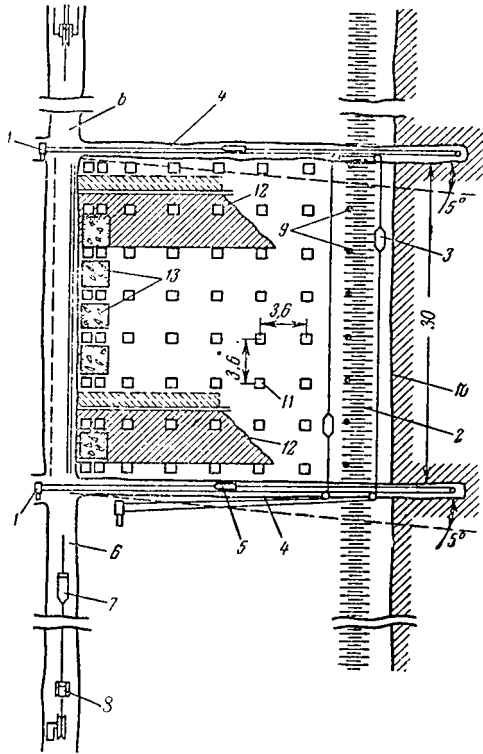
Сплошная система разработки подэтажами по простиранию с поддержанием кровли породными полосами, кострами, временными стойками и бетонными столбами
